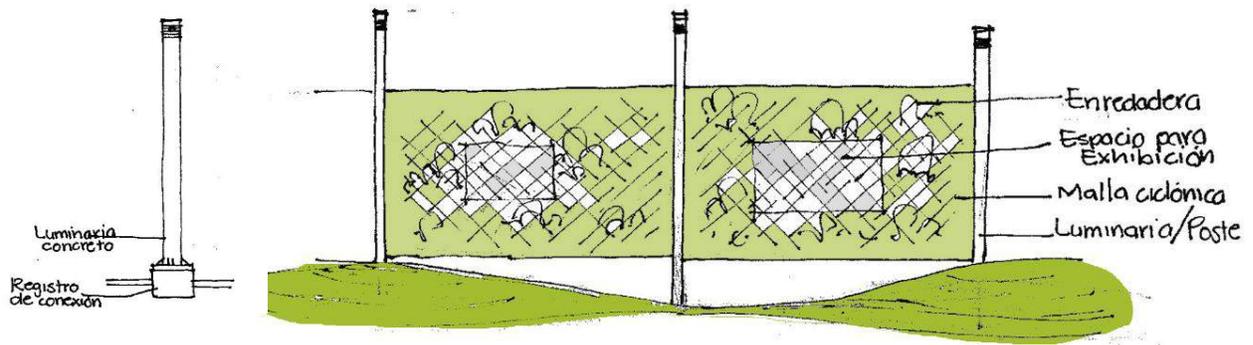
Elementos Urbanos en Parque. (Izquierda) Luminaria de Concreto (derecha) Muro Verde
